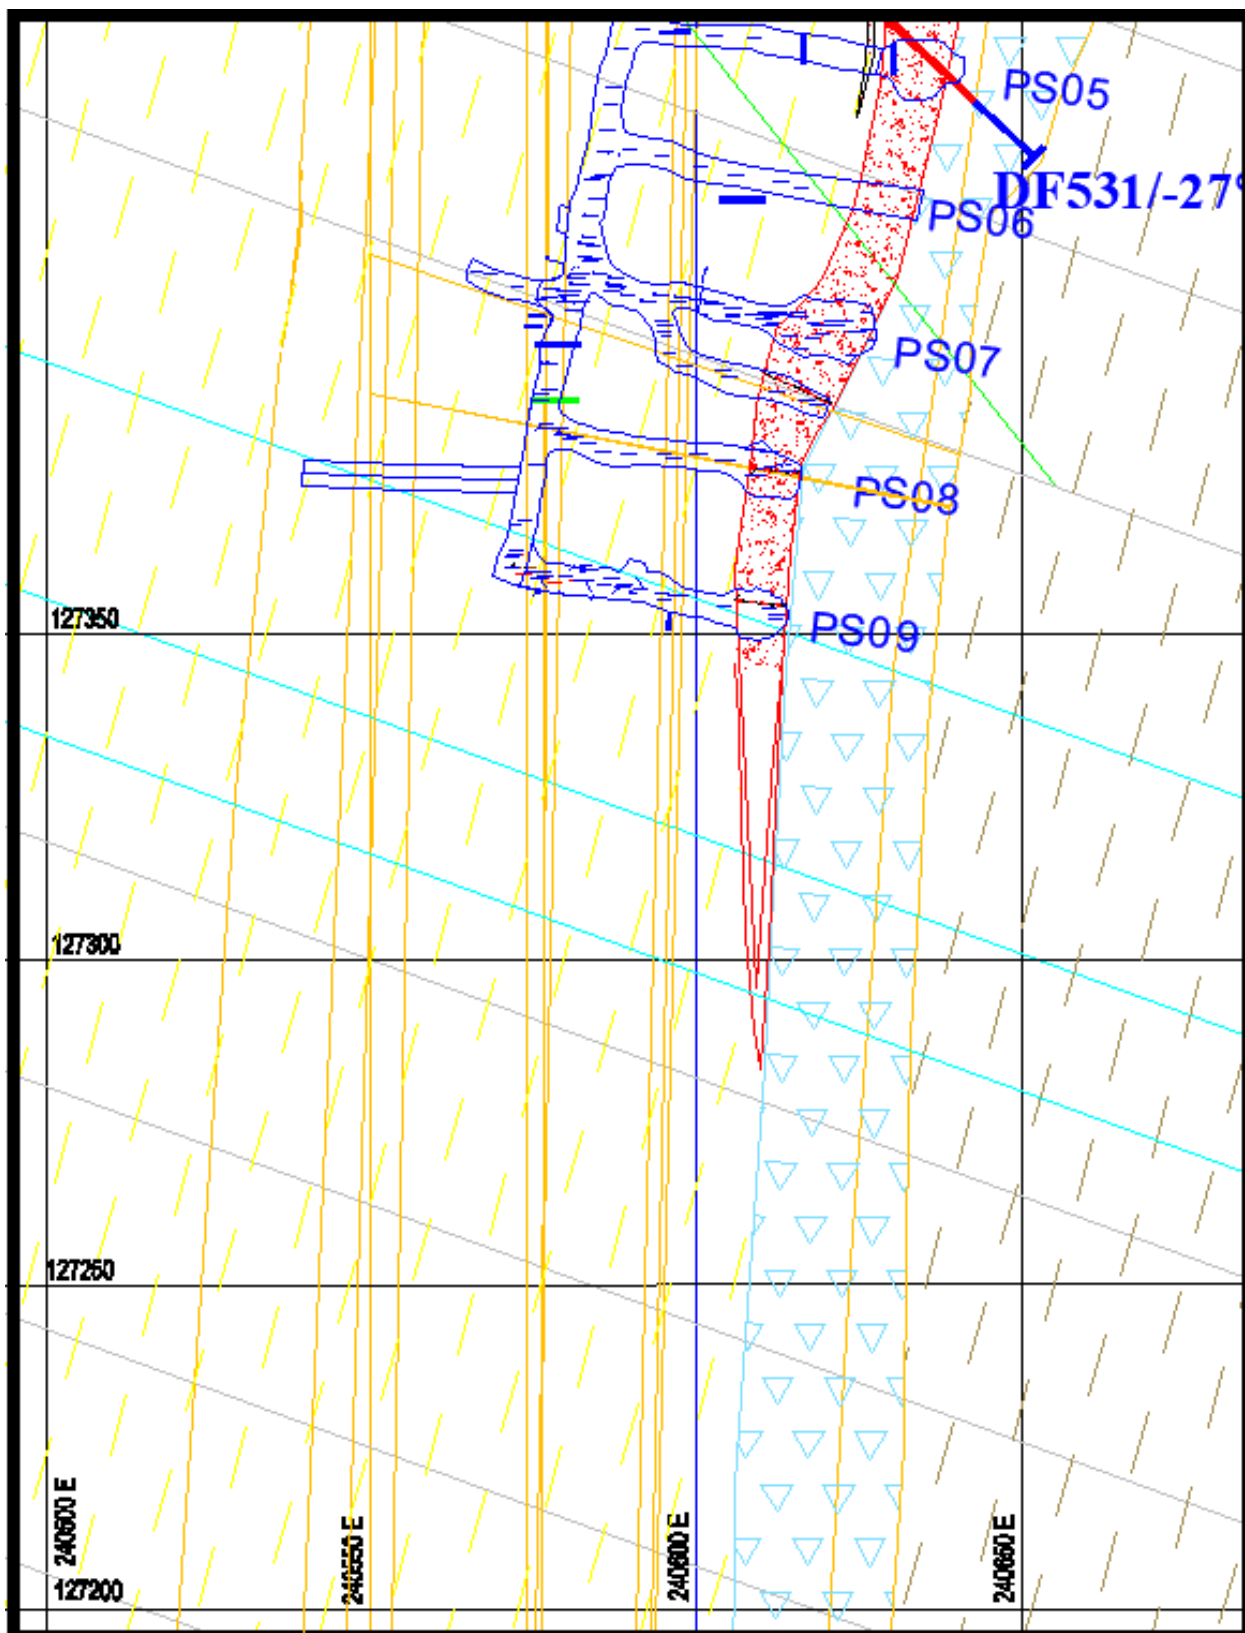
Plan de la mine niveau -1075 (Document interne, CMG Draa Sfar) échelle 1/1000.
